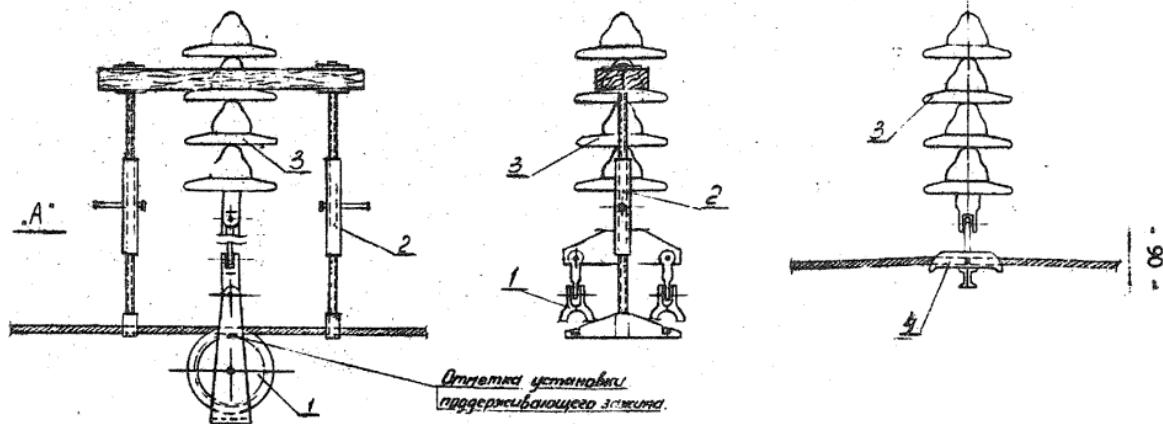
Узел Б" Перекладка проводов без опускания их на землю:
